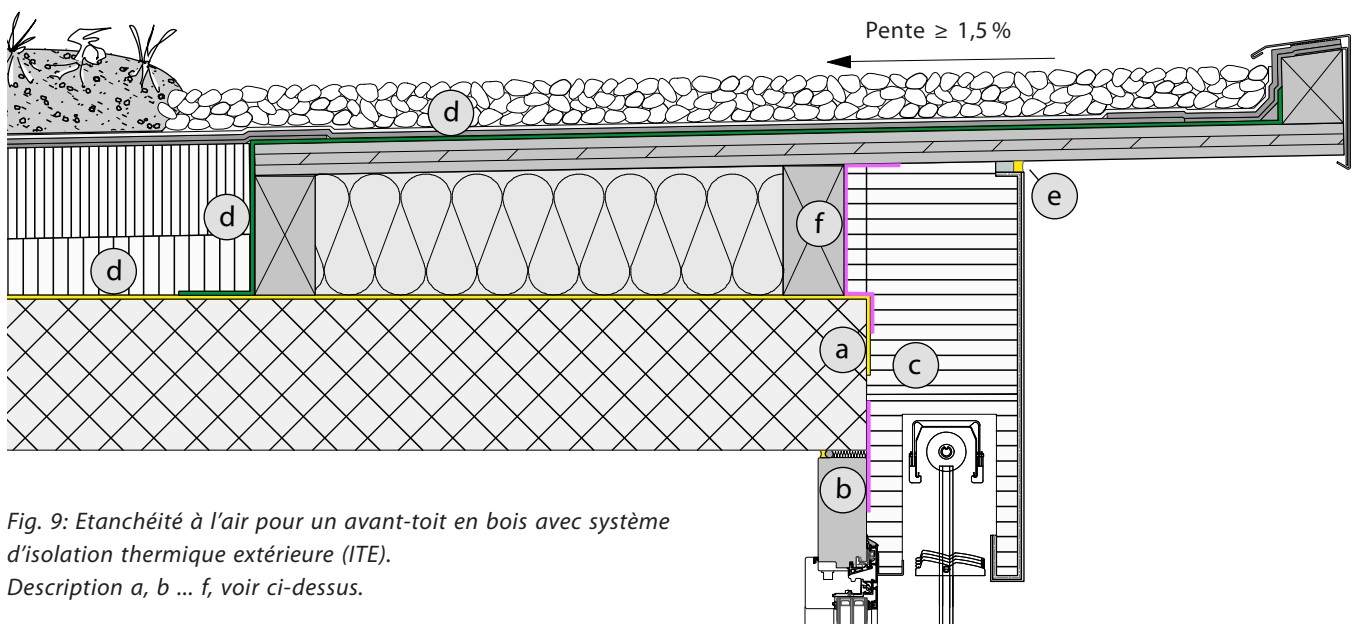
Étanchéité à l'air pour un avant-toit en bois avec système d'isolation thermique extérieure (ITE).
